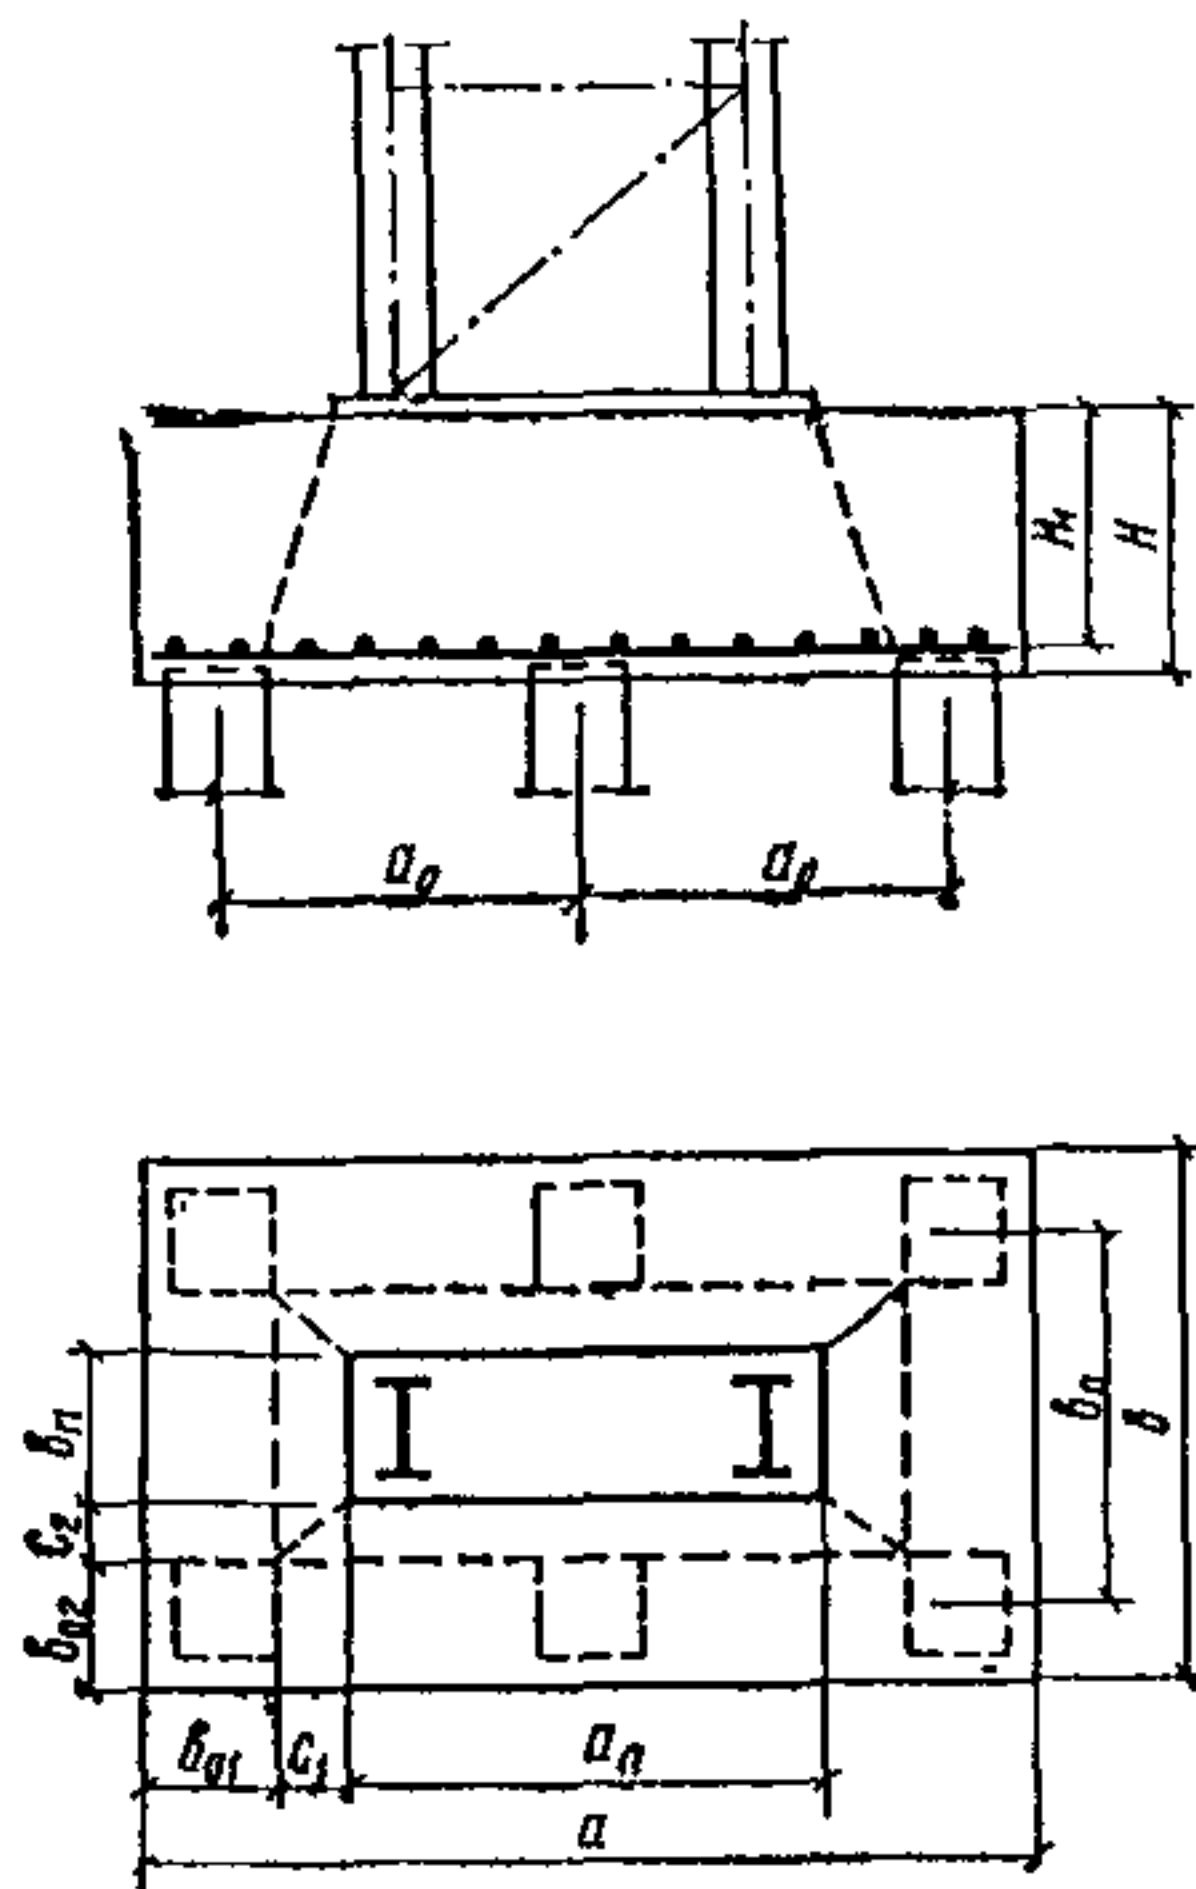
Схема образования пирамиды продавливания при сквозных (решетчатых) колоннах, имеющих единую стальную базу
